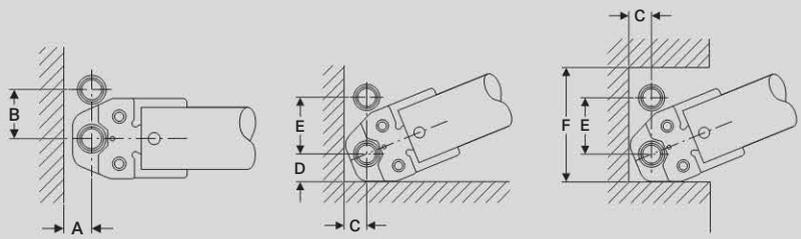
Profondeurs de la conduite pour les traversées de murs et de dalles
